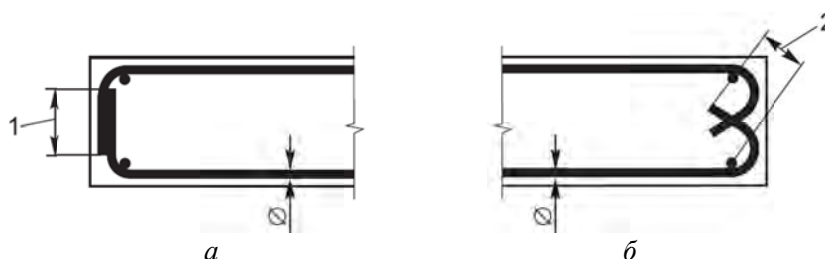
Анкеровка арматуры, работающей на сдвиг:
